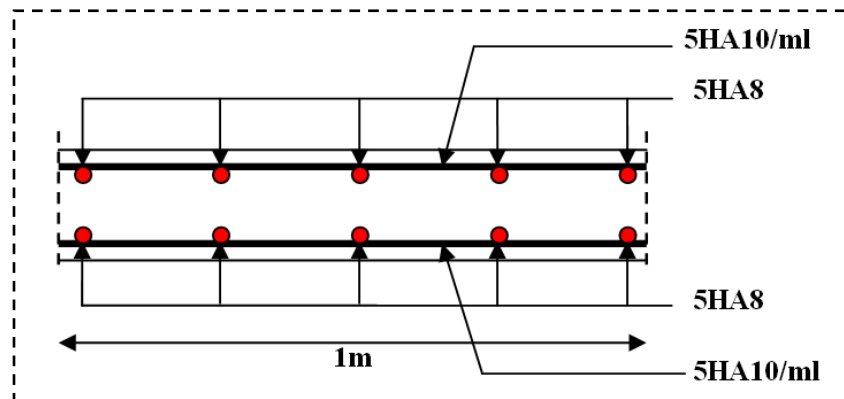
Schéma de ferrailage de la dalle pleine 2^{ème} type
